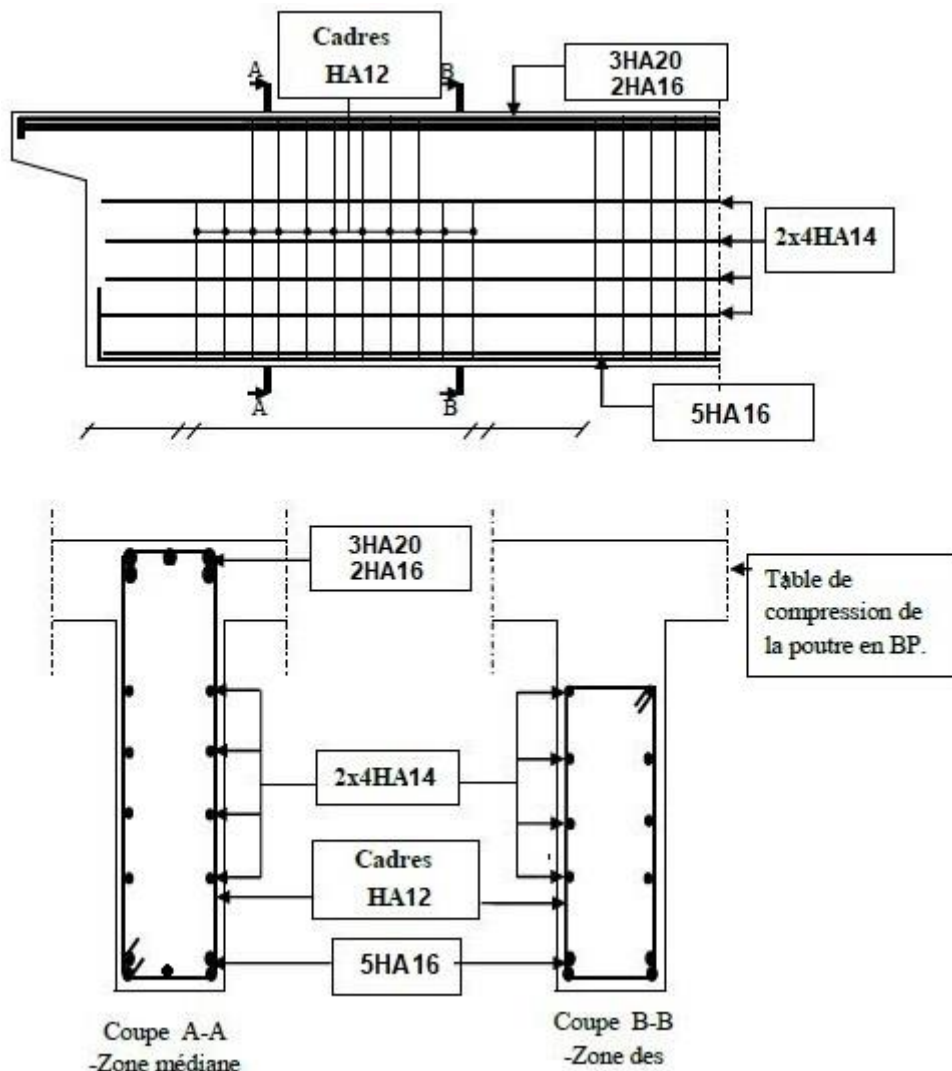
10 : Schéma de ferrailage de l'entretoise
